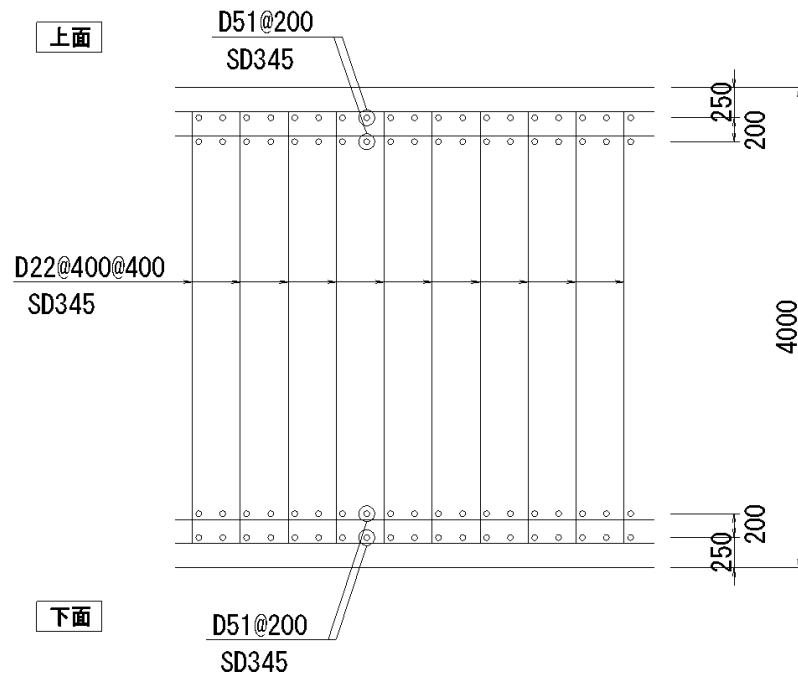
(2) 漂流物対策工基礎スラブの概略配筋図
